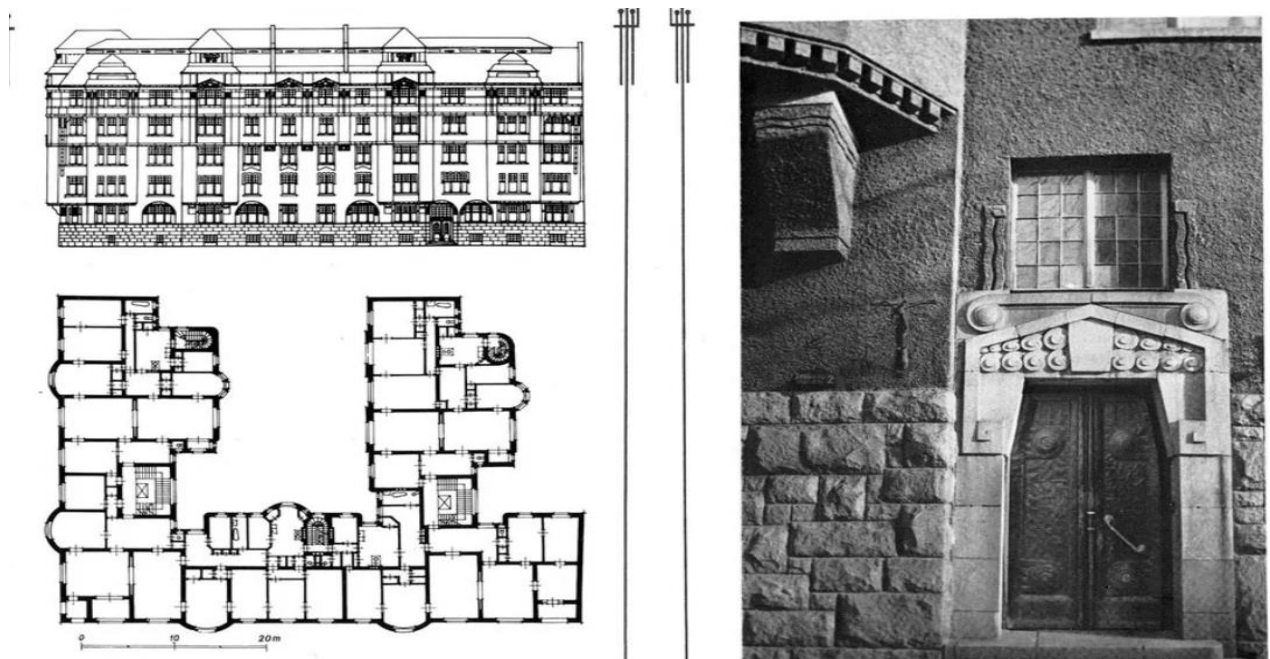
Архитектурно-планировочные решения секционного доходного дома на ул. Алумана, 1906 г. Эскиз фасада, план, фрагмент фасада.
